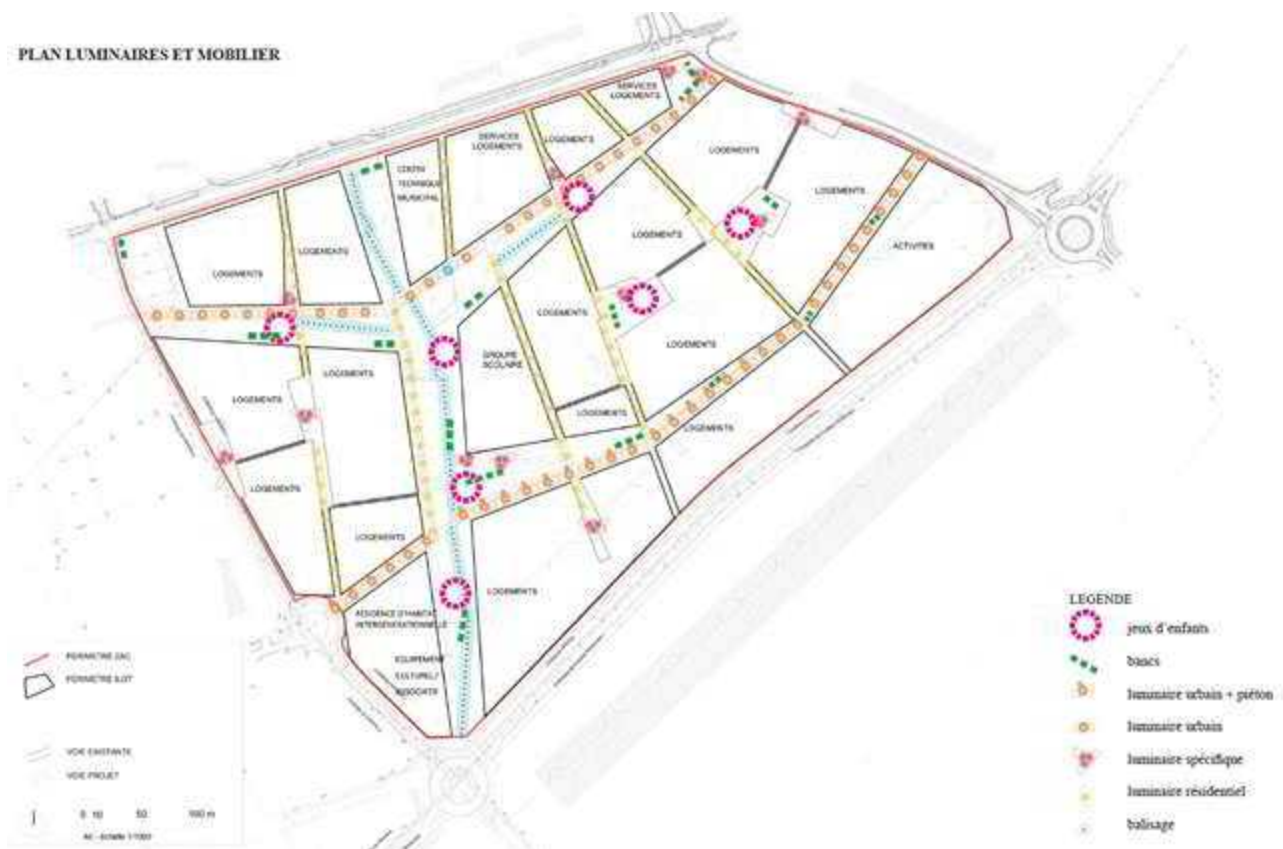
Plan lumière de la ZAC (source : Octa paysage, 2016)
